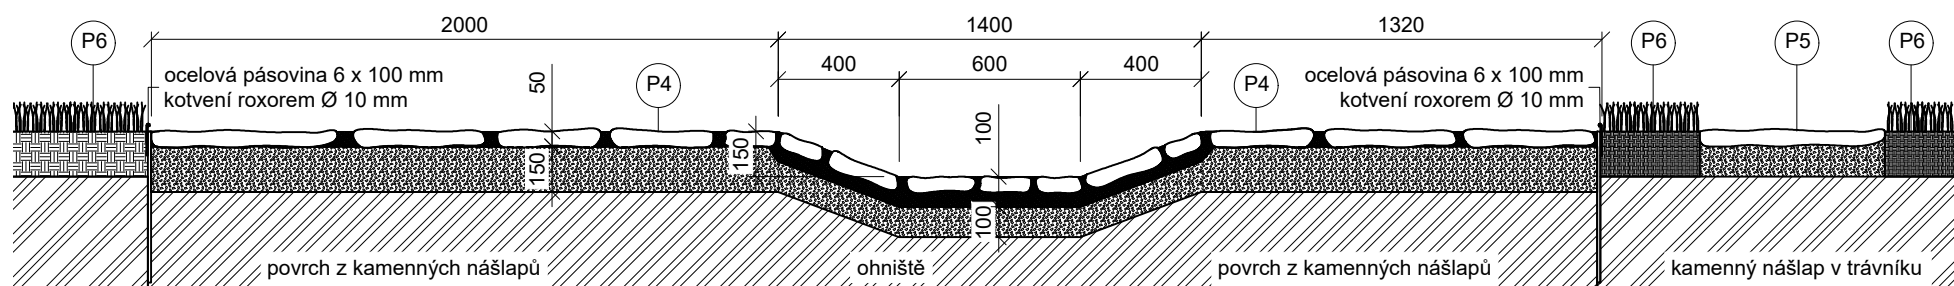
DETAIL SKLADBY OHNIŠTĚ Z KAMENNÝCH NÁŠLAPŮ, M1:10
